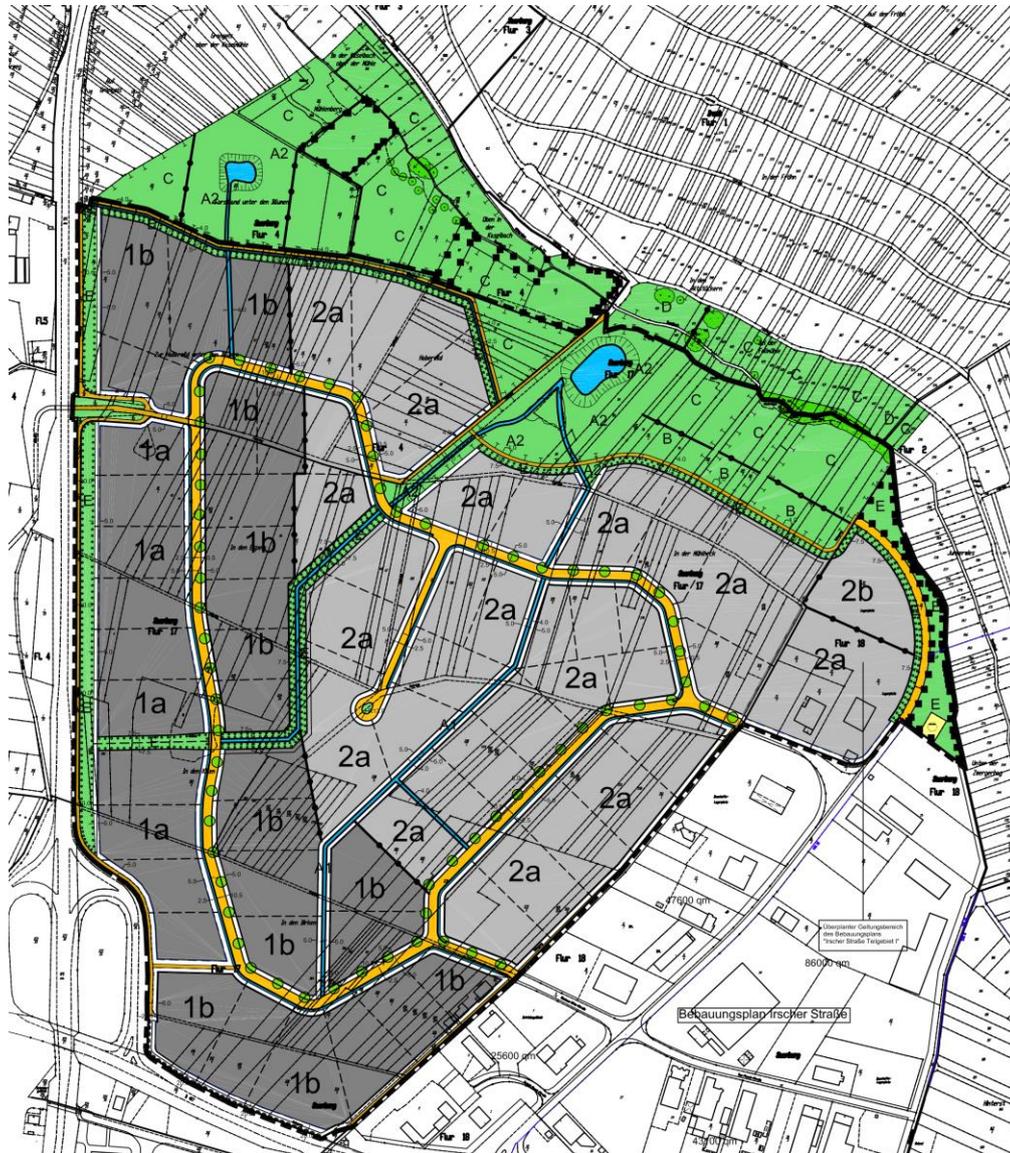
Bebauungsplan „Irscher Straße II“
